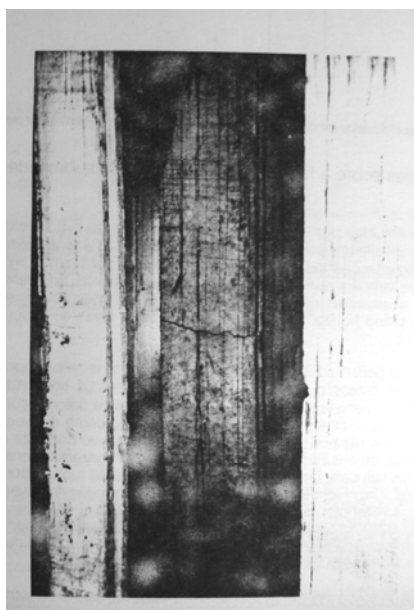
Trincas horizontais a meia altura de painel pré-moldado de concreto armado, submetido à flexocompressão. (Fonte: THOMAZ)
